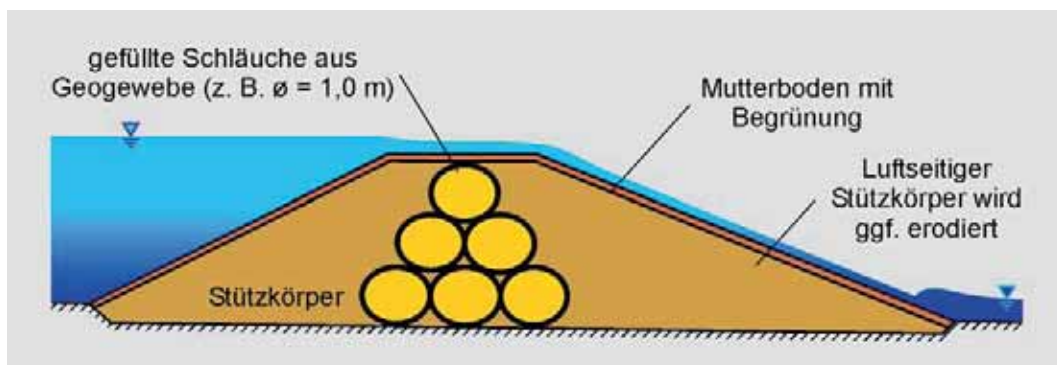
Geogewebeschläuche für überströmbare Dämme.
